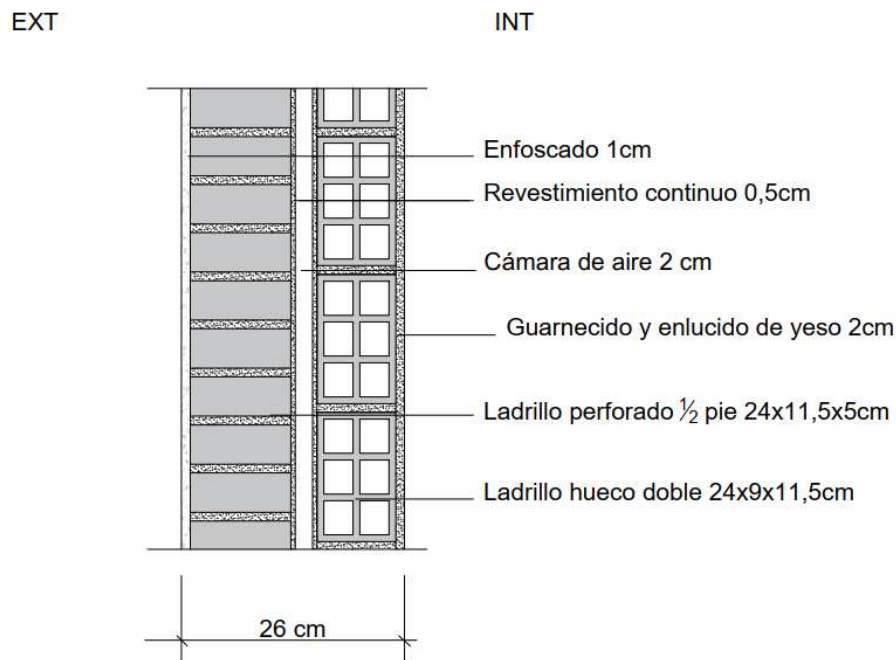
Detalle sección cerramiento exterior. Fuente propia programa AutoCAD
